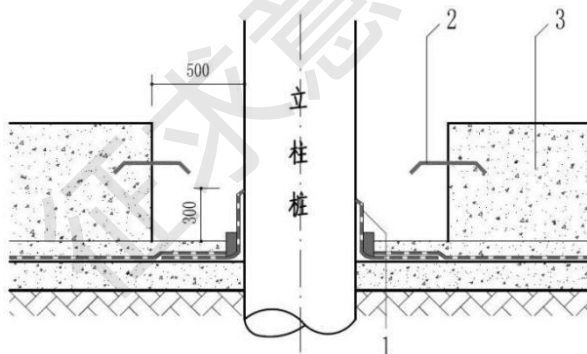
（a）钢筋混凝土立柱与底板节点防水
